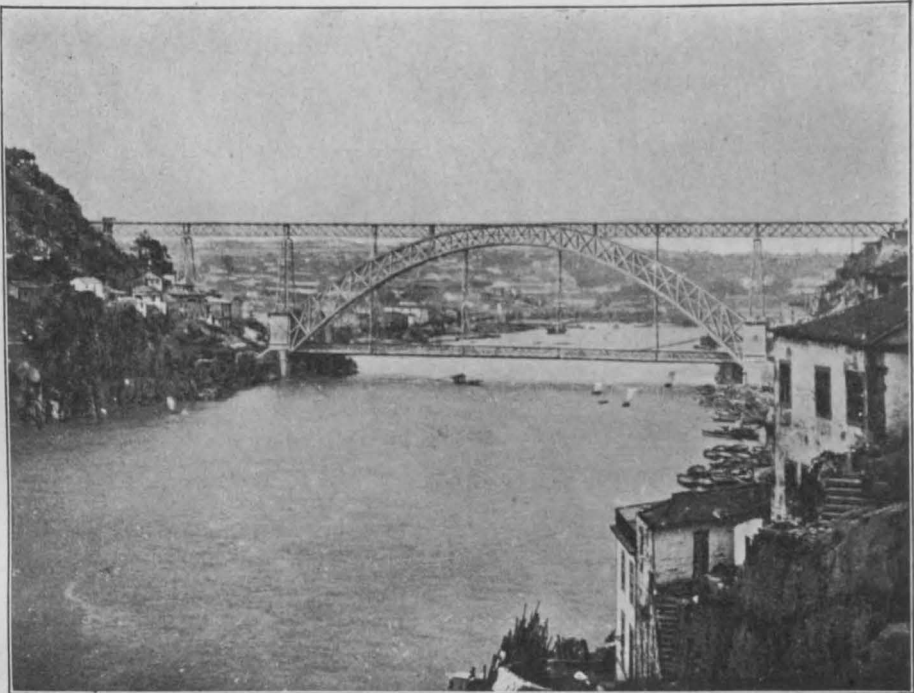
Eisenbahnbrücke Luiz I über den Douro bei Porso. 1885. 160 m Stützweite.
